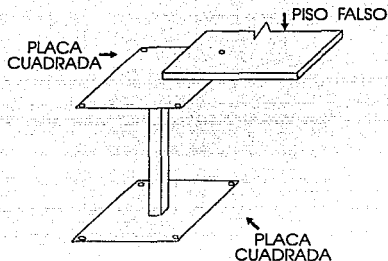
PISO FALSO EN PLANTA BAJA
